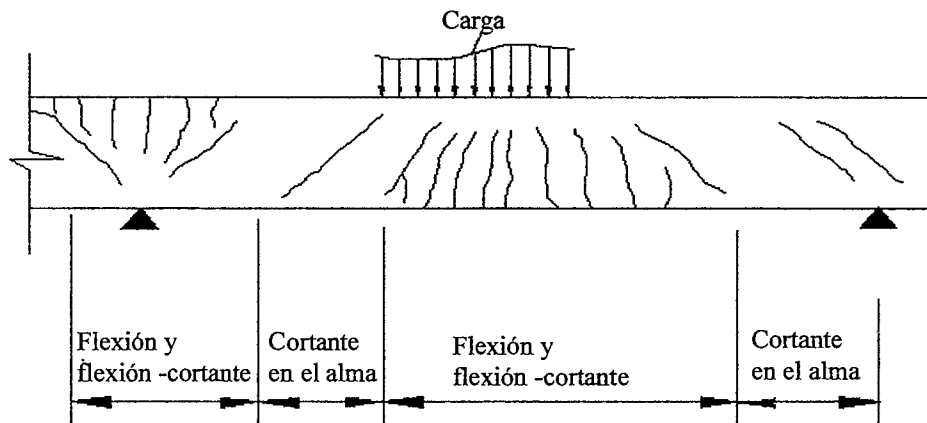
Tipos de agrietamiento en vigas de concreto armado.
